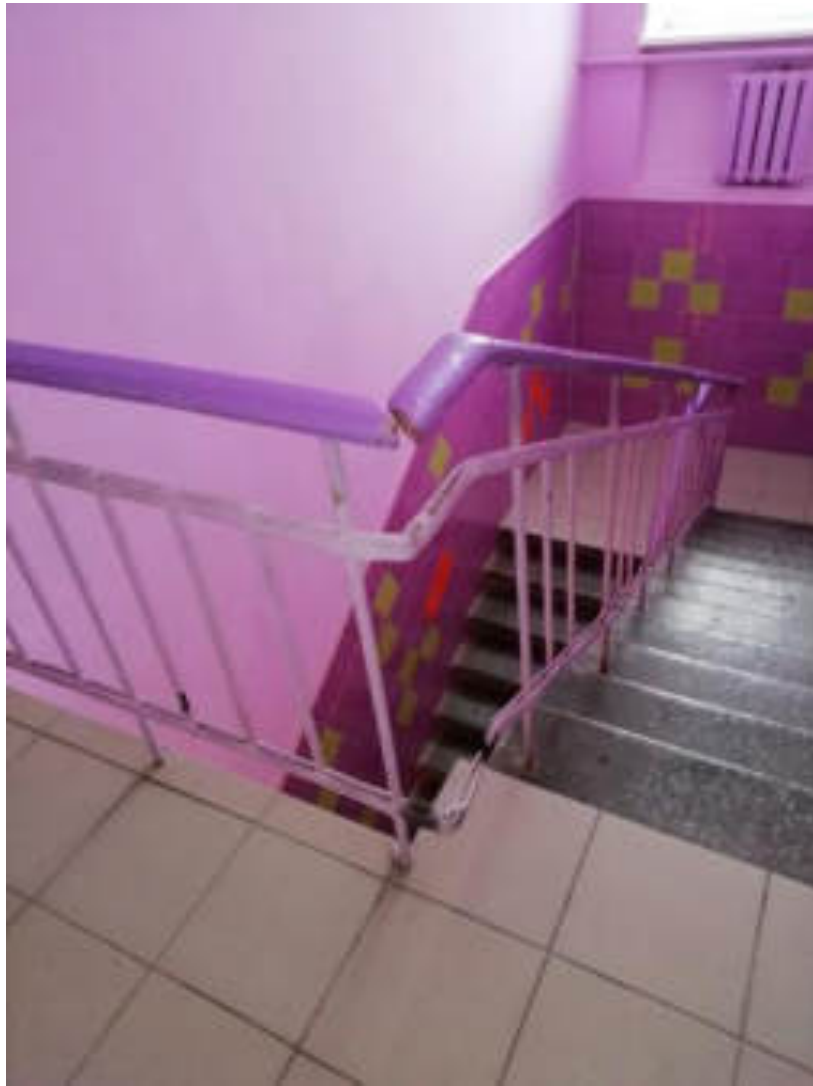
Лестница 1 корпус 1. Наборные ступени по металлическим косоурам.
